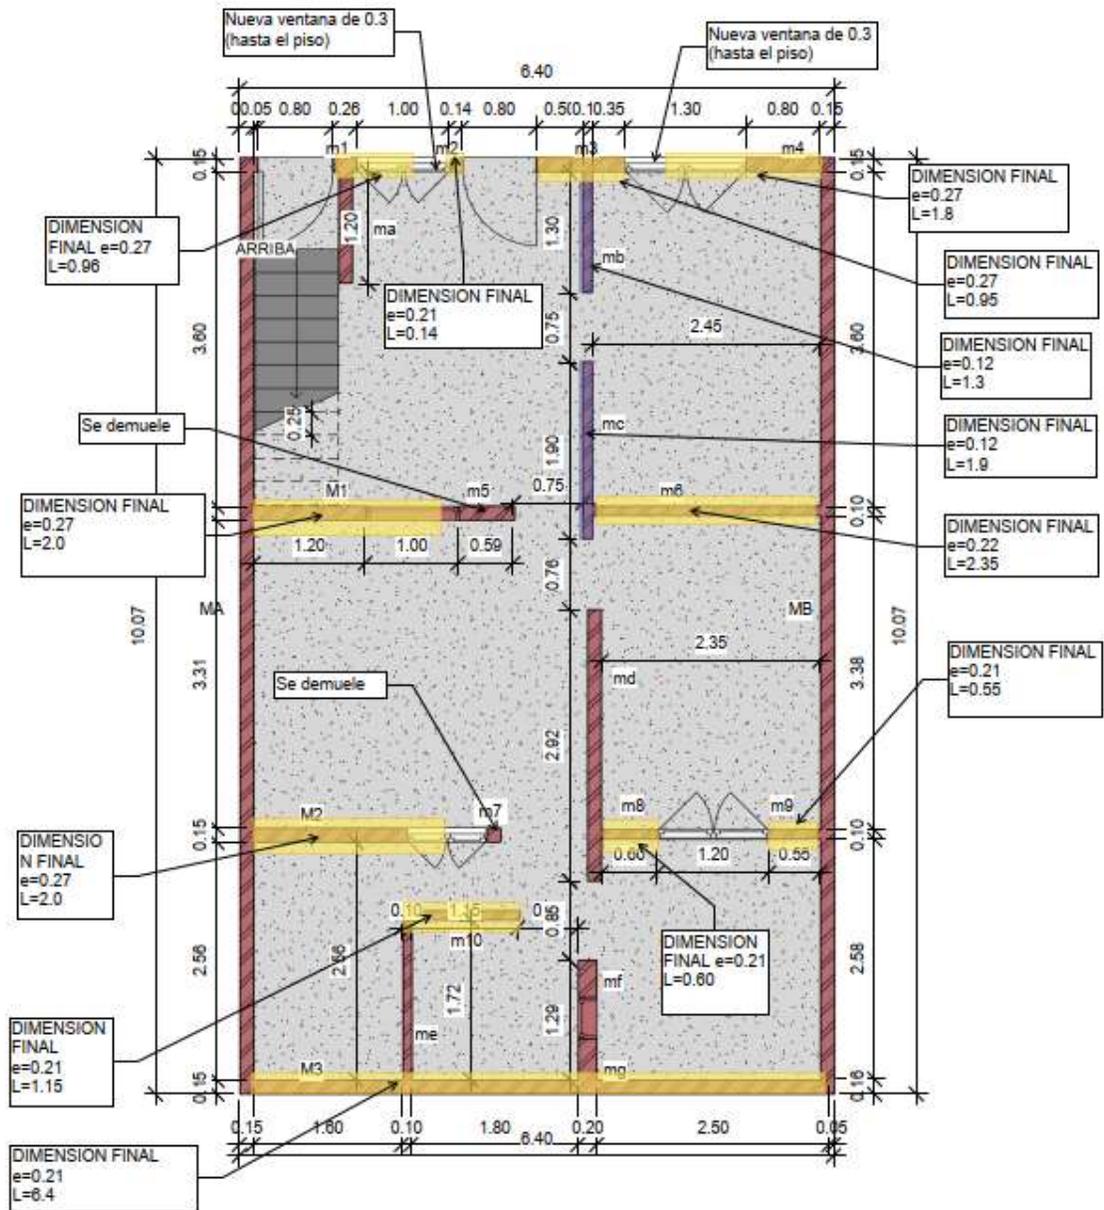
Representación gráfica de reforzamiento de muros en Nivel 1 (dimensiones en m). Fuente Elaboración propia
